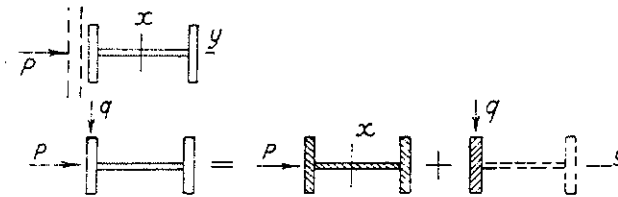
Sơ đồ tính tải trọng tường tác dụng lên dầm sườn tường
